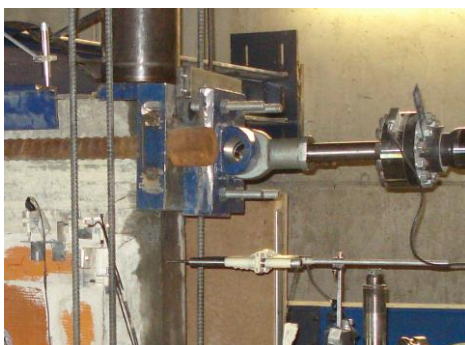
Pormenorização das bases metálicas de apoio.
